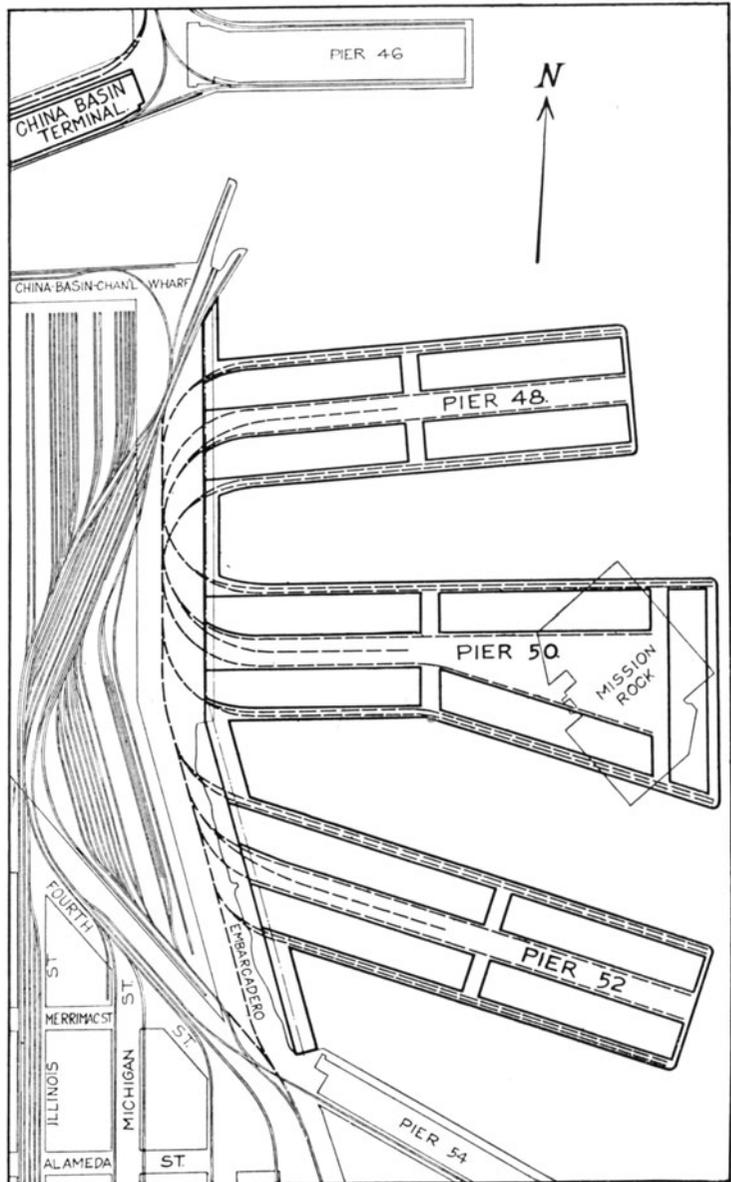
Lageplan des zum Bau beschlossenen Projektes, Piers 48-50.
